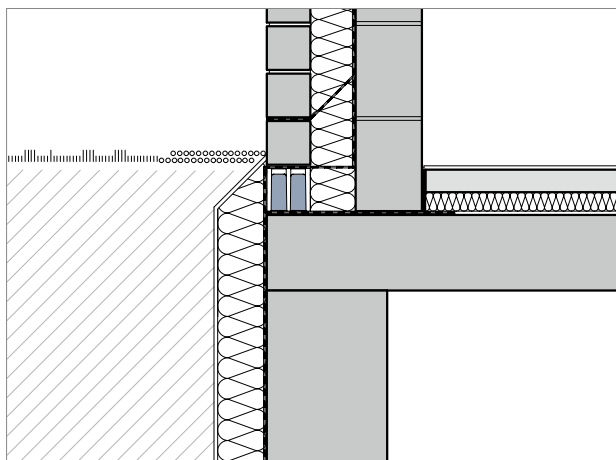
Schöck Sconnex® typ M u obvodové stěny na základové konstrukci
